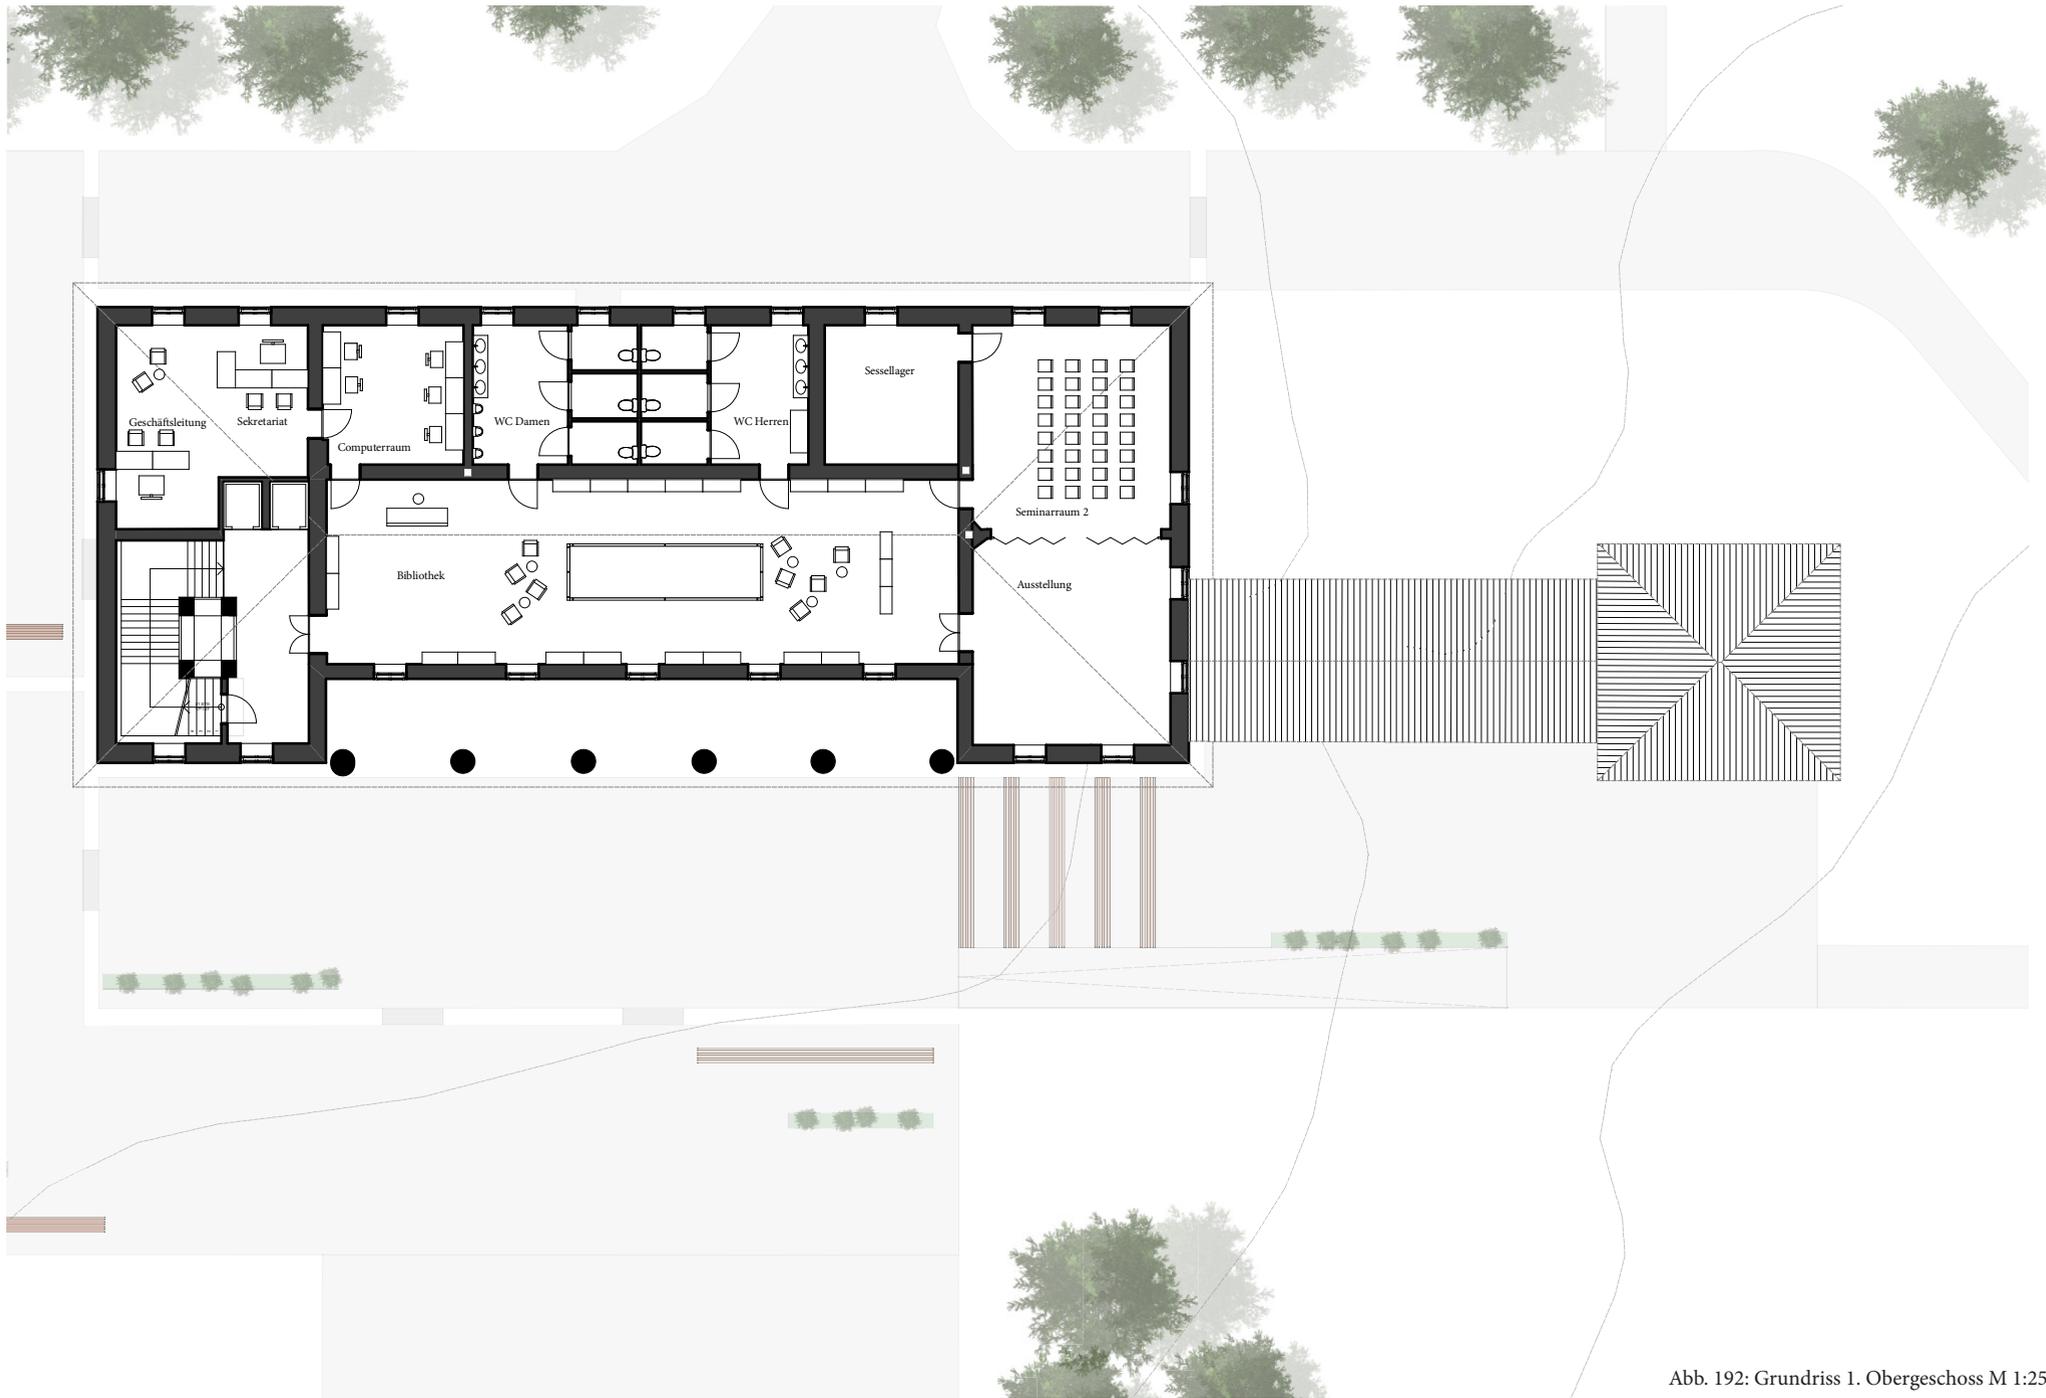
Grundriss 1. Obergeschoss M 1:250
